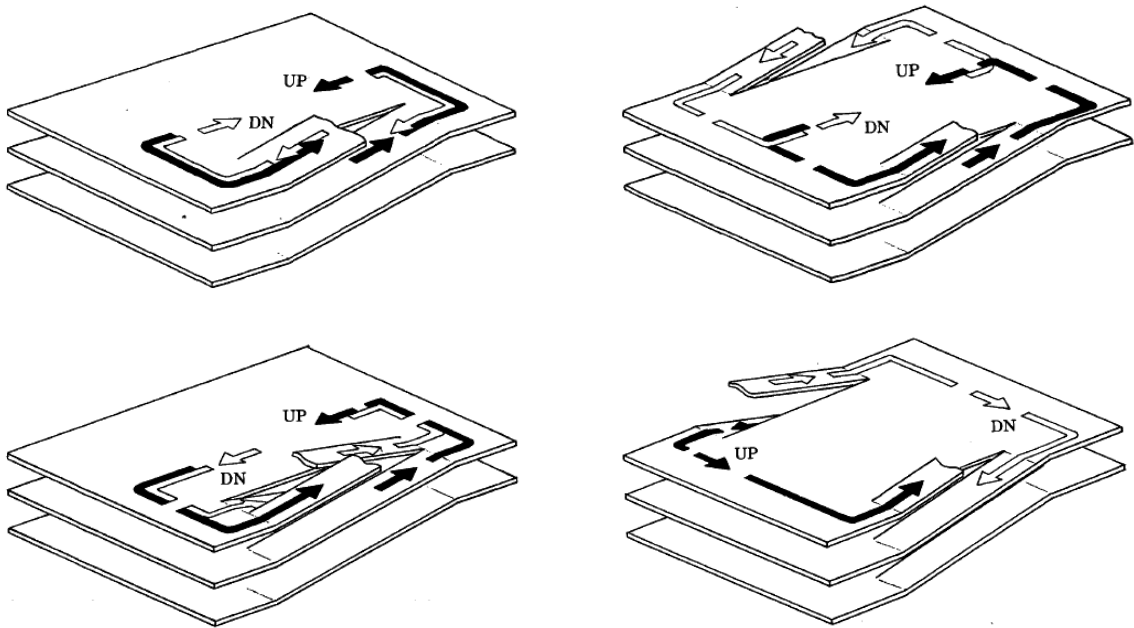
Exemplos de layout com rampas retas, segundo Weant (1978)
